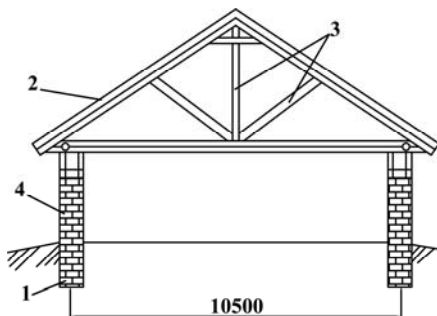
Безкаркасна конструктивна схема с.-г. будівлі:
